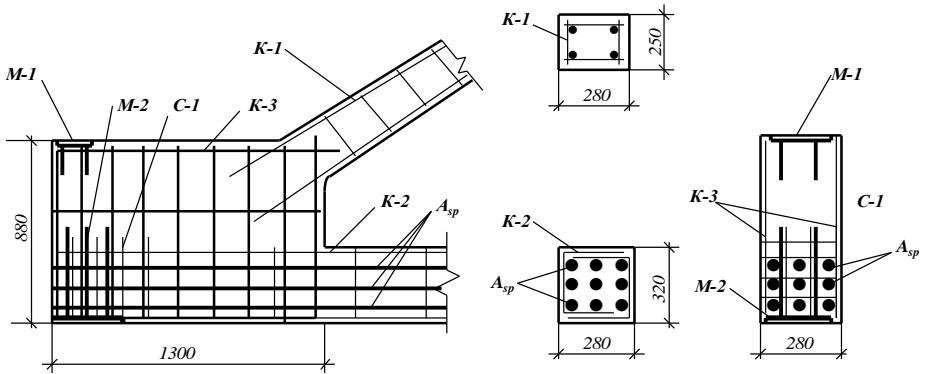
Конструювання безкісцевої ферми покриття
